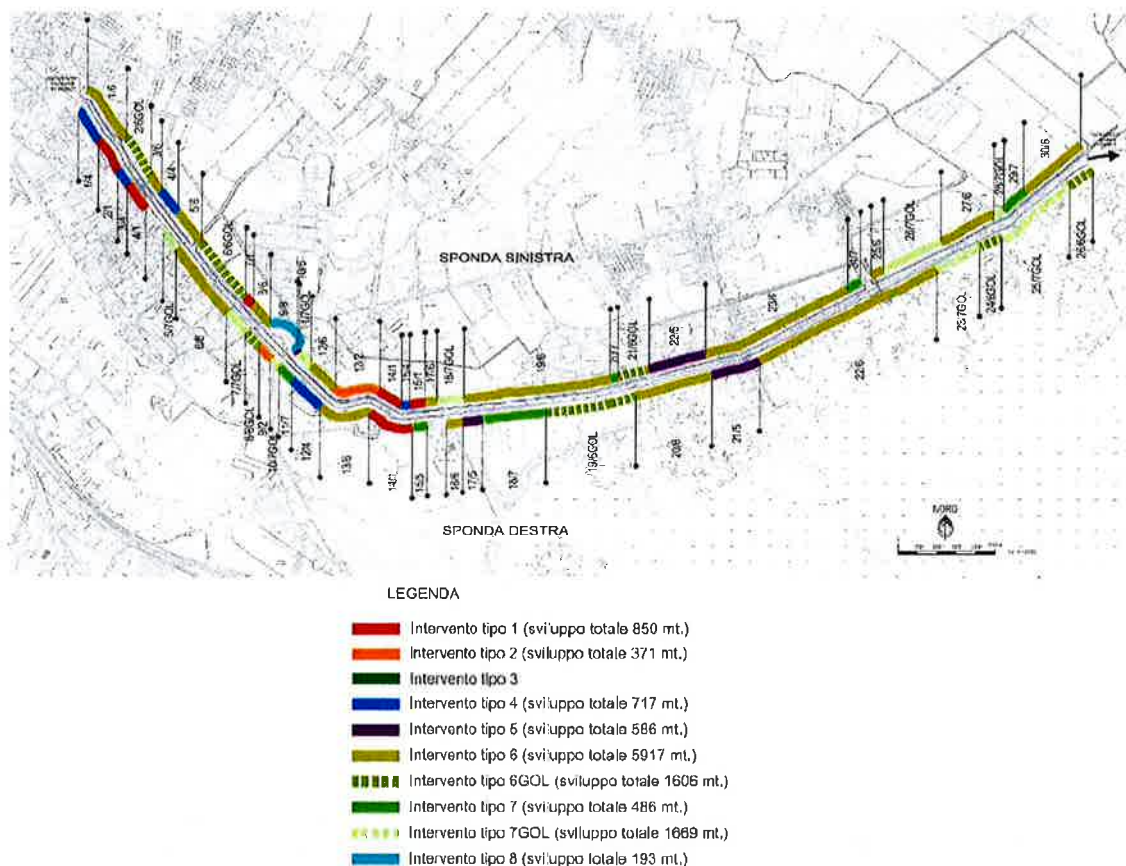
Planimetria generale degli interventi del progetto complessivo.
